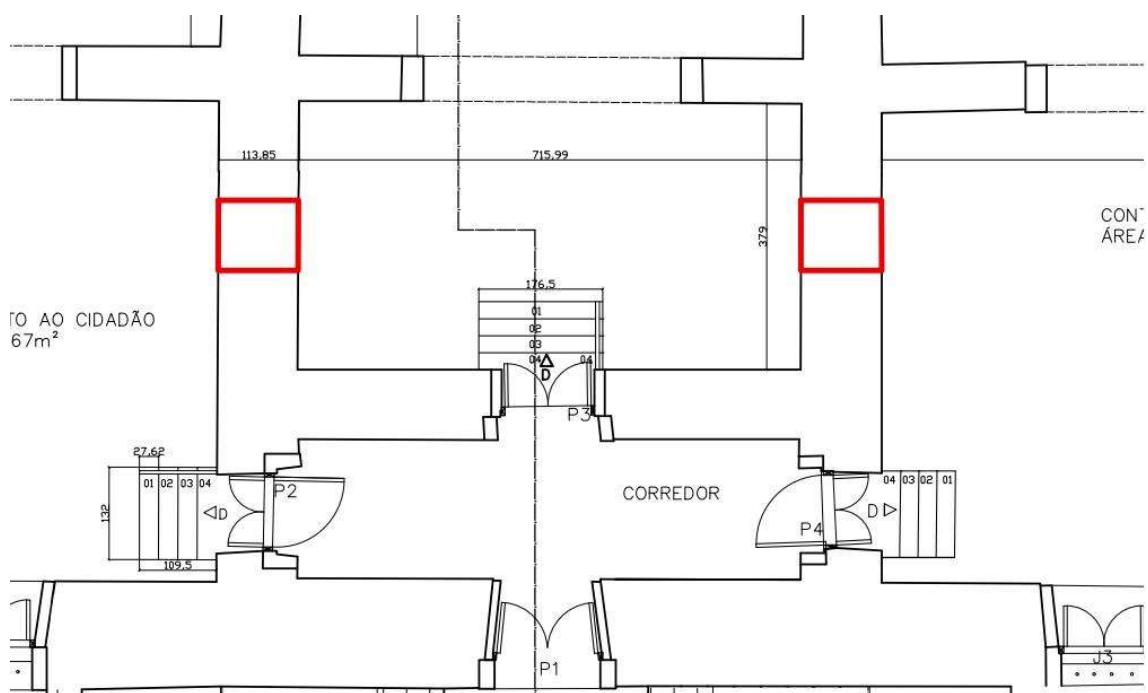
Corte apresentando a intervenção proposta com dois elevadores
